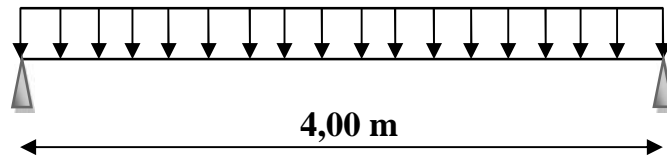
Schéma statique de la poutre palière.
